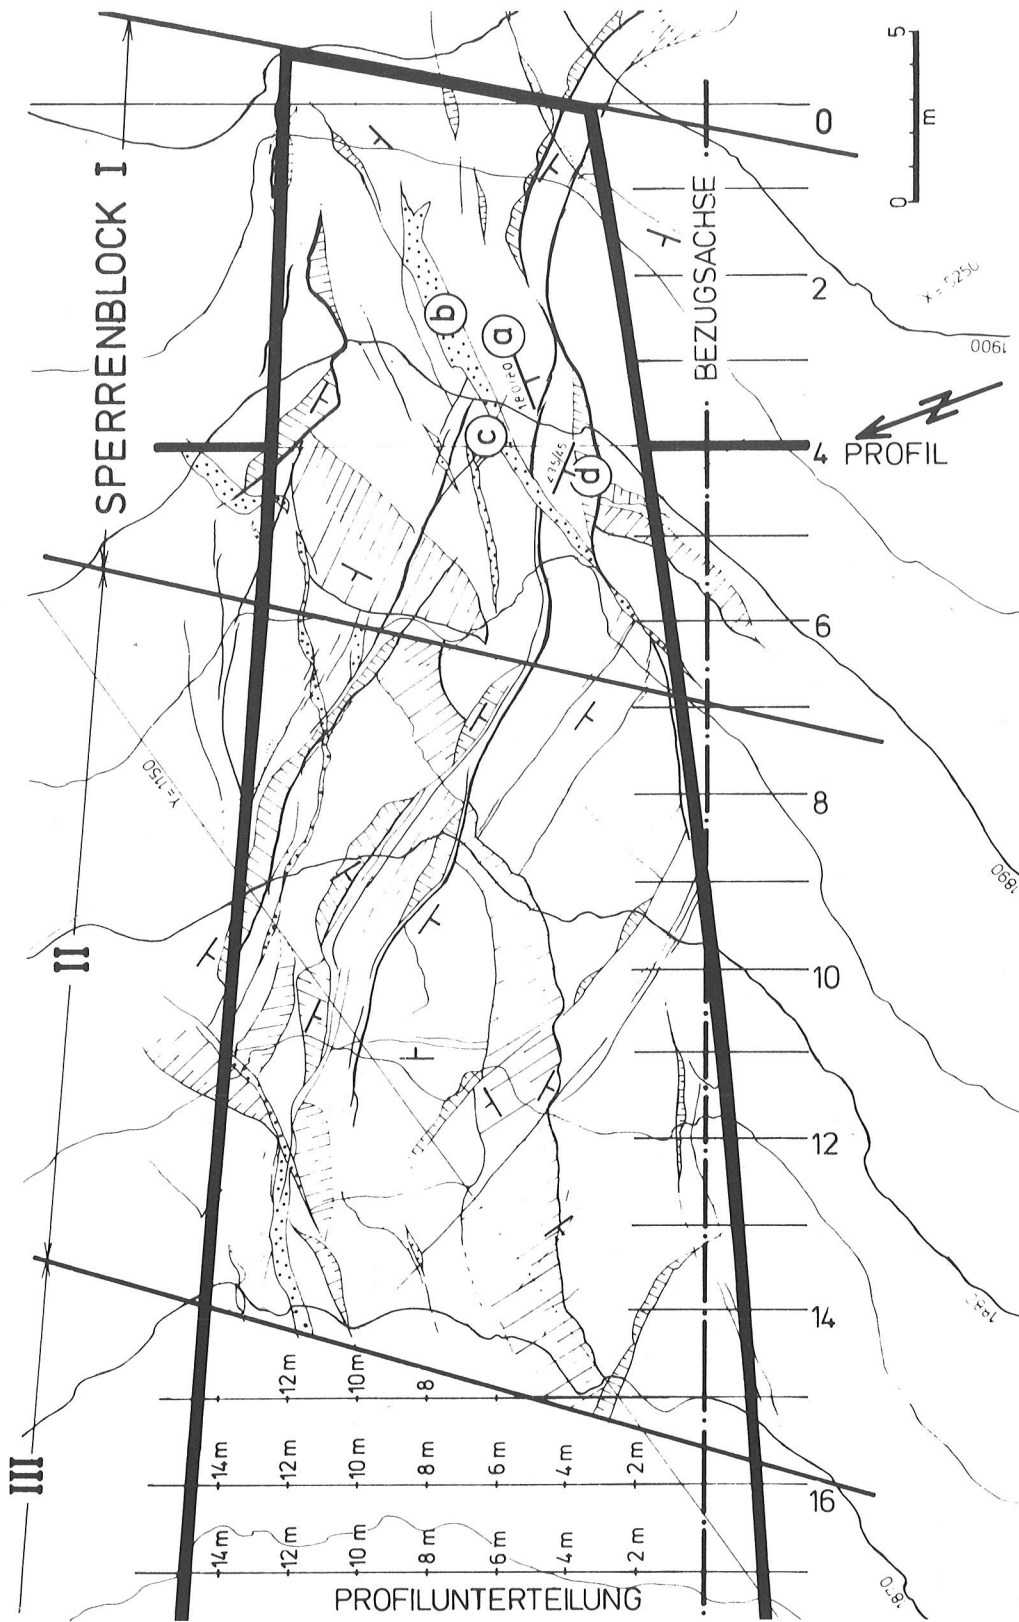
Kölnbreinsperre, Ausschnitt aus dem Lageplan der Gründungsfläche
